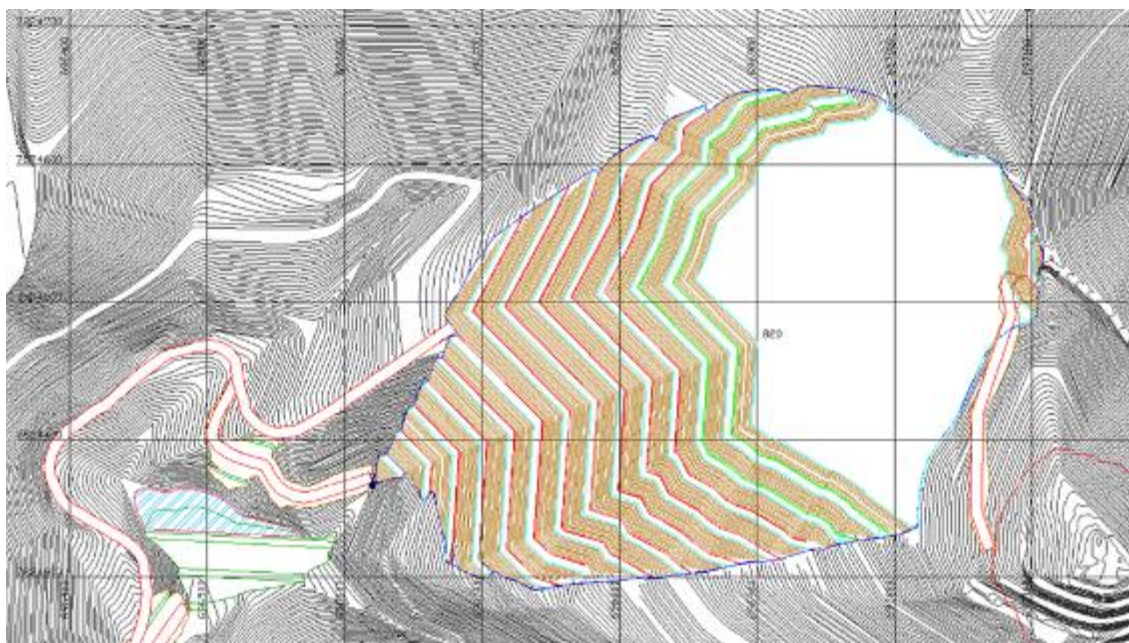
Vista em planta da geometria final da Pilha de Estéril.
